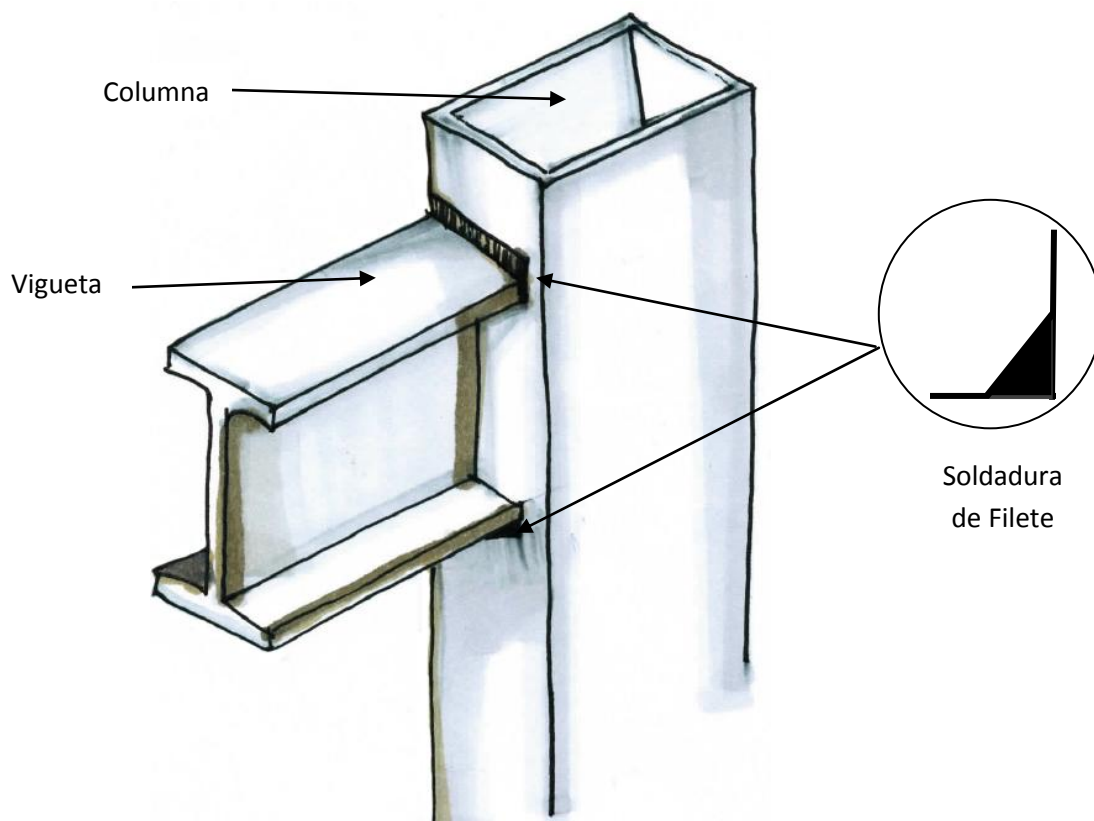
Detalle de unión a base de soldadura de filete
